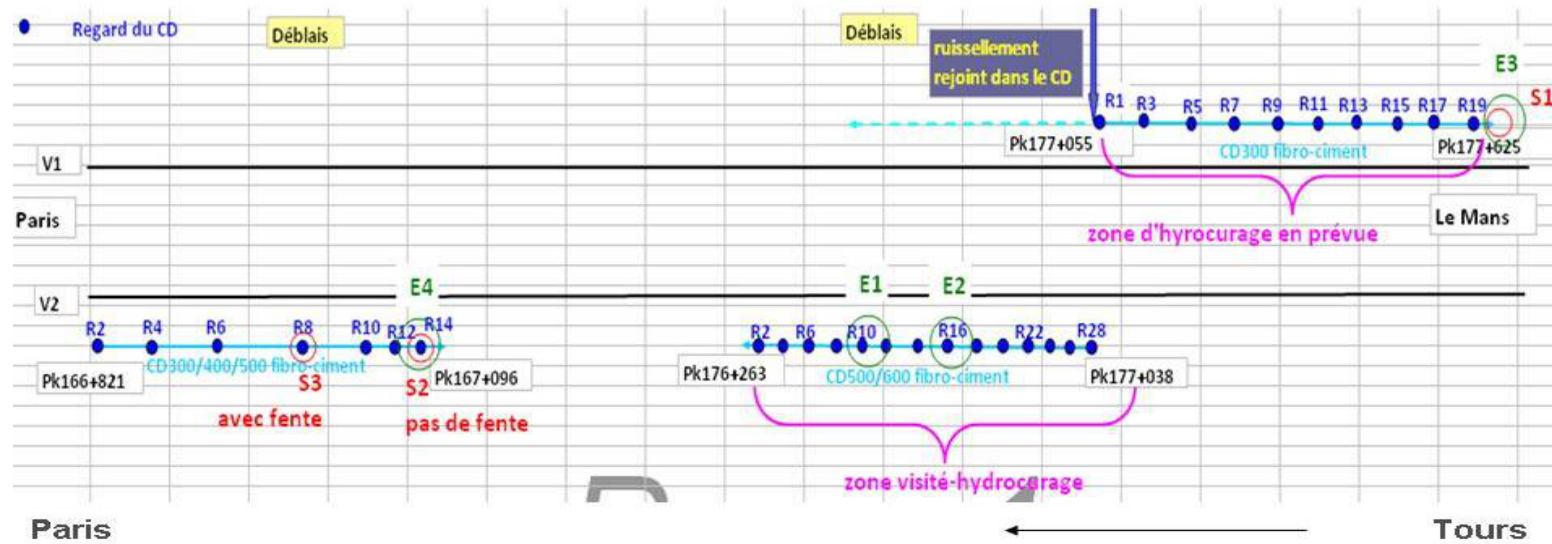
schéma de principe du système de drainage et plan d'échantillonnage sur le site de Connerré
